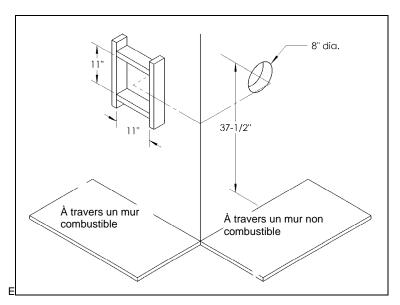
Dimension des trous pour installations à égalité avec le mur. Pour les installations où l'appareil est loin du mur, il doit y avoir 1/4" de montée pour chaque 12" de conduit horizontal.
